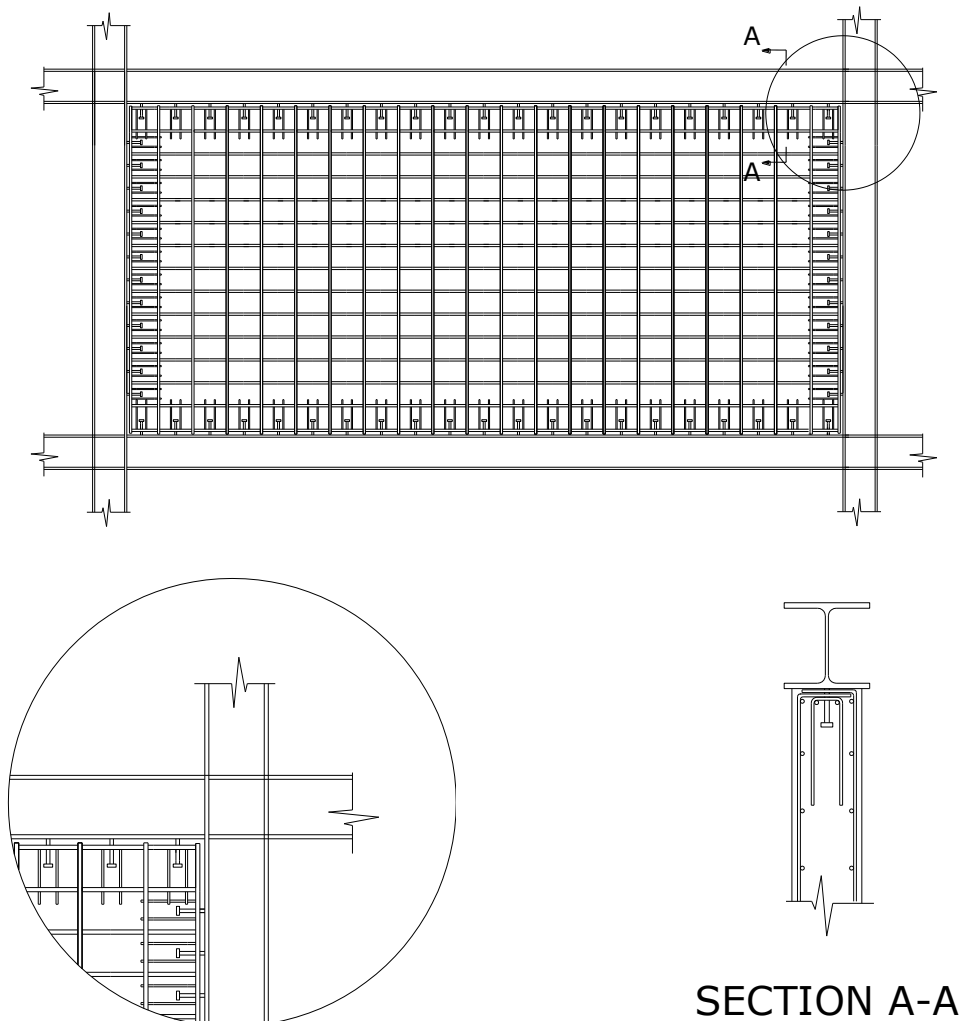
Muro de rigidización de hormigón armado en una estructura metálica y detalles típicos de refuerzo para pernos conectores sometidos a tracción (AISC 2010) (9).
